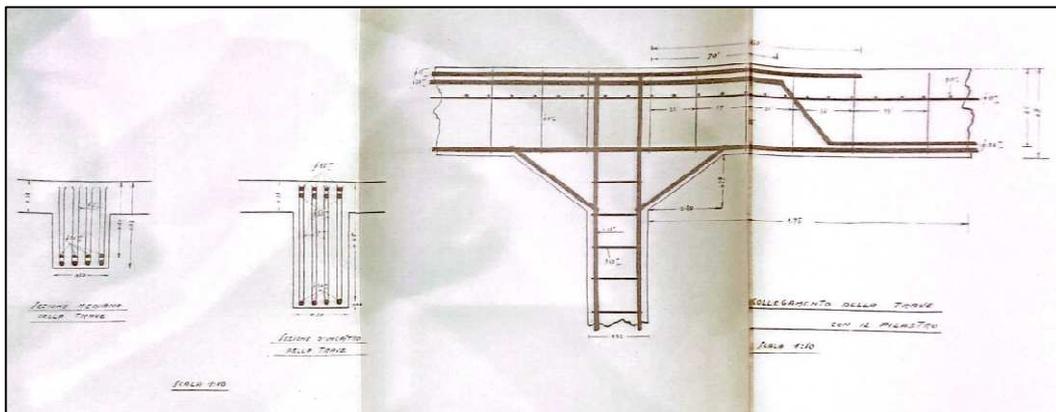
Cosenza. Particolare del collegamento trave-pilastro solaio serbatoio acquedotto Merone. Progetto dell'Ingegnere Tommaso Gualano, 1930 – Scala 1:10.
